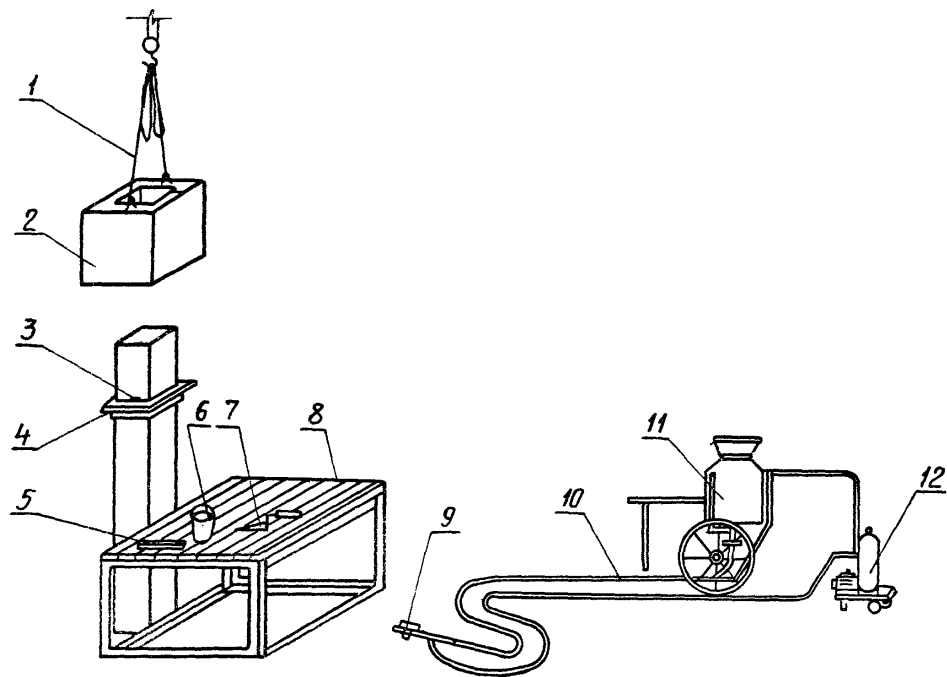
Монтаж оголовка: 1-четырёхветвевой строп; 2-оголовка; 3-отметка низа оголовка; 4-монтажный хомут; 5-уровень; 6-ведро; 7-рельсы; 8-инвентарные подмости; 9-сопло; 10-шланг; 11-пневматический нагнетатель конструкции ЦНИИОМГП; 12-компрессор
